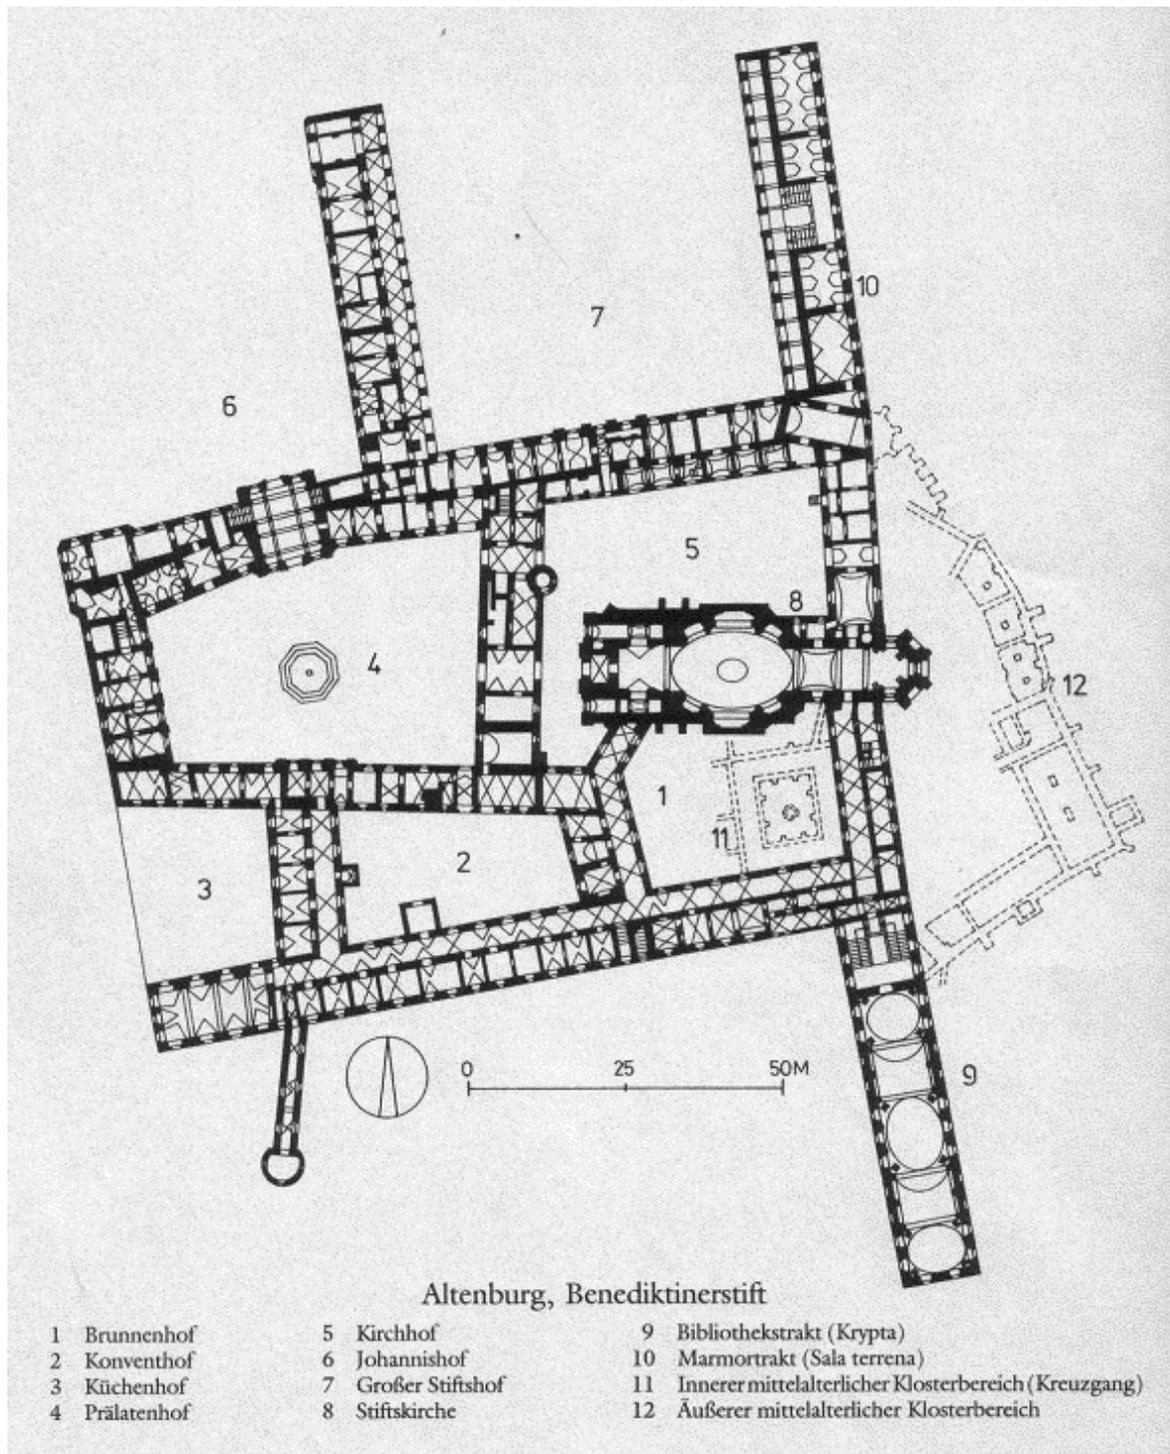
Altenburg, Benediktinerstift Altenburg, Grundriss
